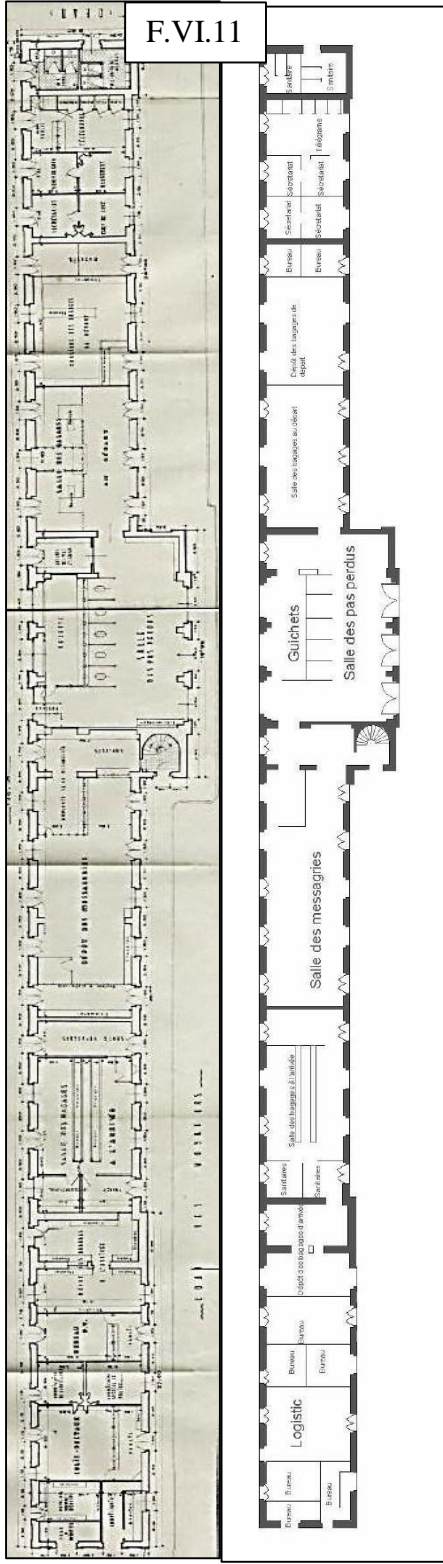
Plan du rez-de-chaussée de la gare centrale d'Alger
